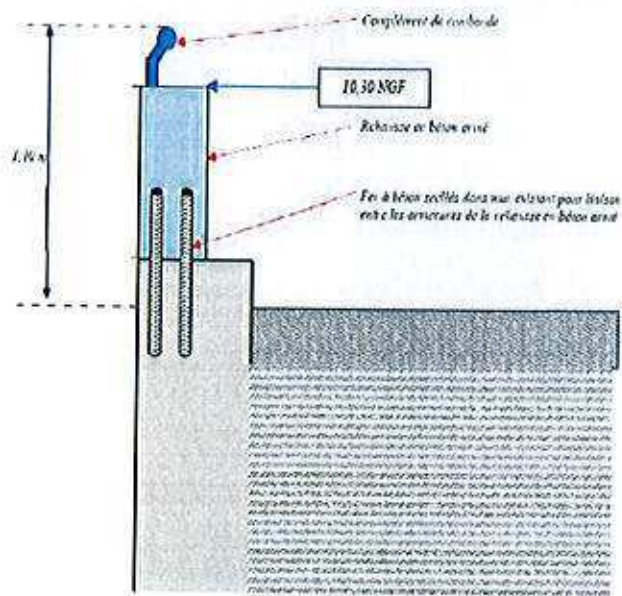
Coupe de principe de la rehausse de la prise d'eau BRL
